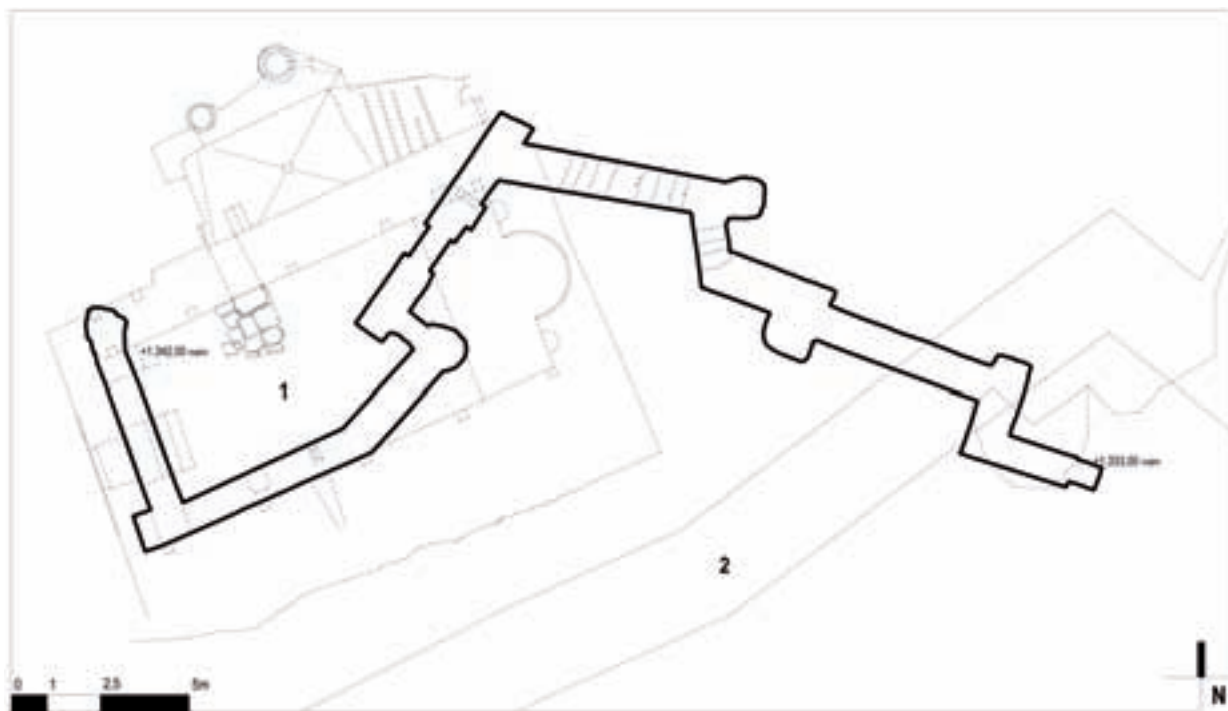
Rilievo della galleria della Chiesa Ipogea orientato rispetto alla pianta della chiesa (rilievo Burri & Parise; disegno Di Paolo).
